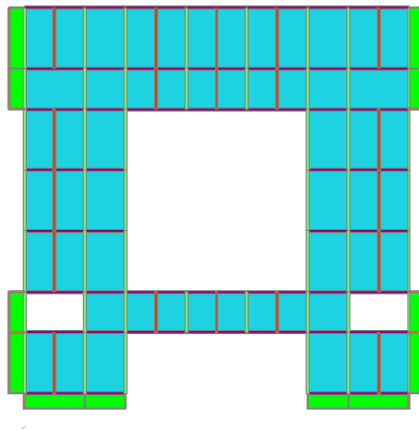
1Perencanaan Bangunan bentuk 3D
